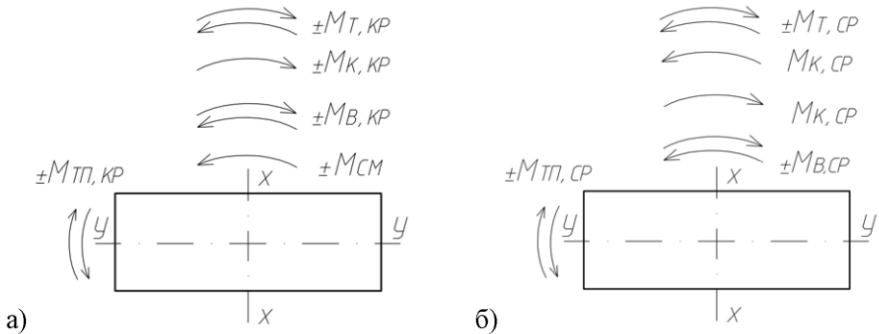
Схема дії згинаючих моментів на фундаменти крайньої (а) і середньої (б) колони.
